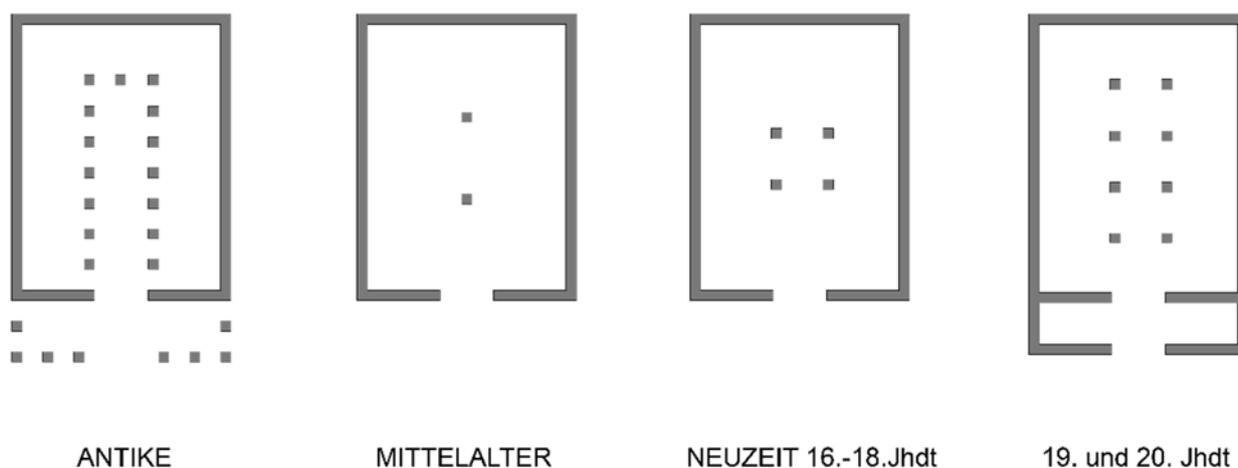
Schematische Grundrissdarstellung über verschiedene Epochen
